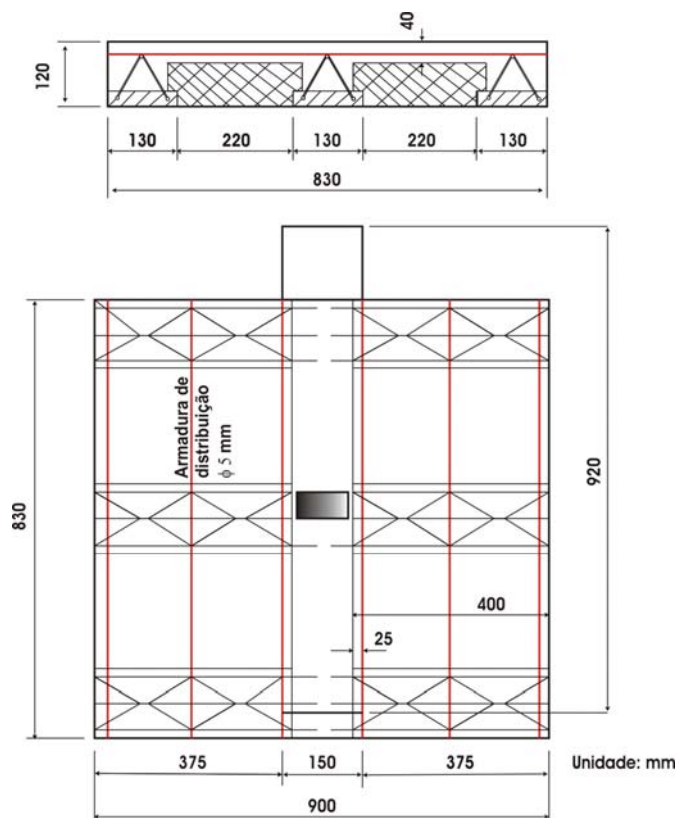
Dimensões da laje do ensaio de cisalhamento direto (DAVID, 2003)
